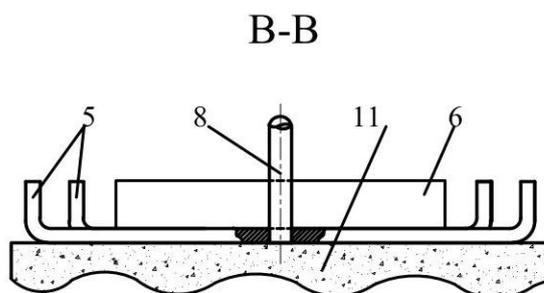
Сечение *B—B* элемента II: 5 — клемма для жесткого крепления граням панелей; 6 — ребро жесткости; 8 — арматура; 11 — фундамент
